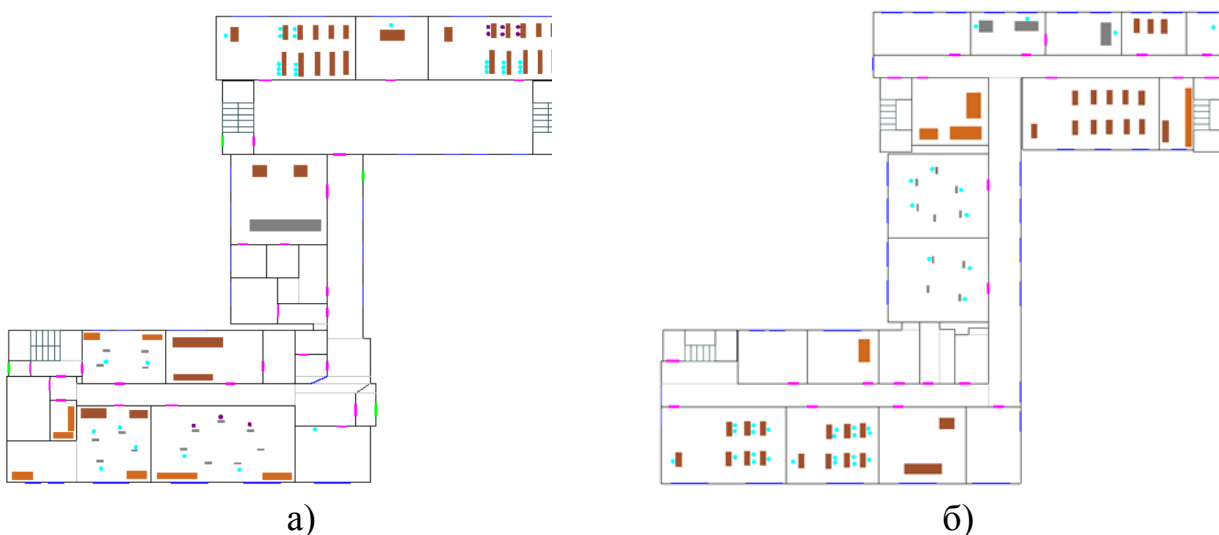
Сценарии эвакуации: а) на первом этаже здания; б) на втором этаже здания
